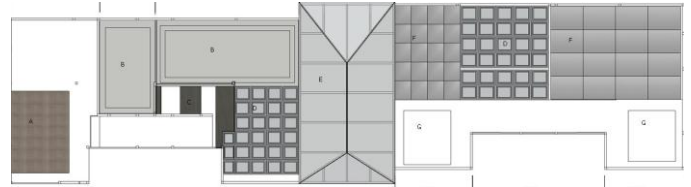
menampilkan layout lantai dua perancangan *Art Development and Activity Center*. Layout pada lantai dua ini secara keseluruhan hanyalah area semi privat dengan area kelas dan hanya ada satu area privat yaitu *back office* yang hanya dapat di akses oleh yang berkepentingan. Pada bangunan sayap kiri terdapat *back office area* dan *fashion design area*, sedangkan di bangunan sayap kanan terdapat *free zone activity area, interior design area* dan *visual communication area*. *Free zone activity area* lantai dua diakses melalui tangga yang berada di dalam *free zone activity area* lantai satu.
